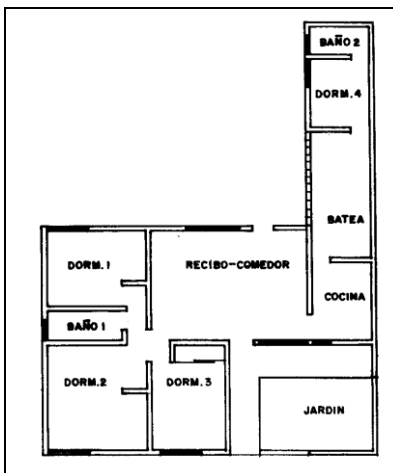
e. Vivienda SJ-1. Planta (1952)
